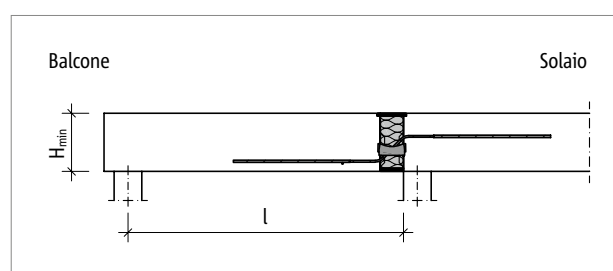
Schöck Isokorb® T tipo QL-V2 – V6: sistema statico
